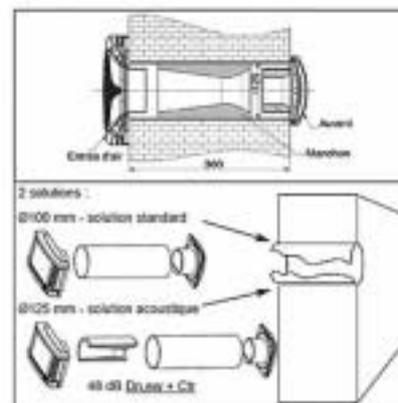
exemple d'installation d'une entrée d'air en traversée de mur avec ou sans manchon acoustique
